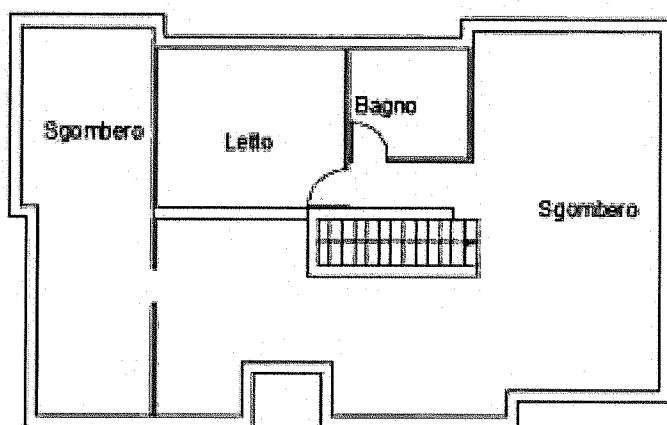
Planimetria Piano Primo – Situazione esistente
